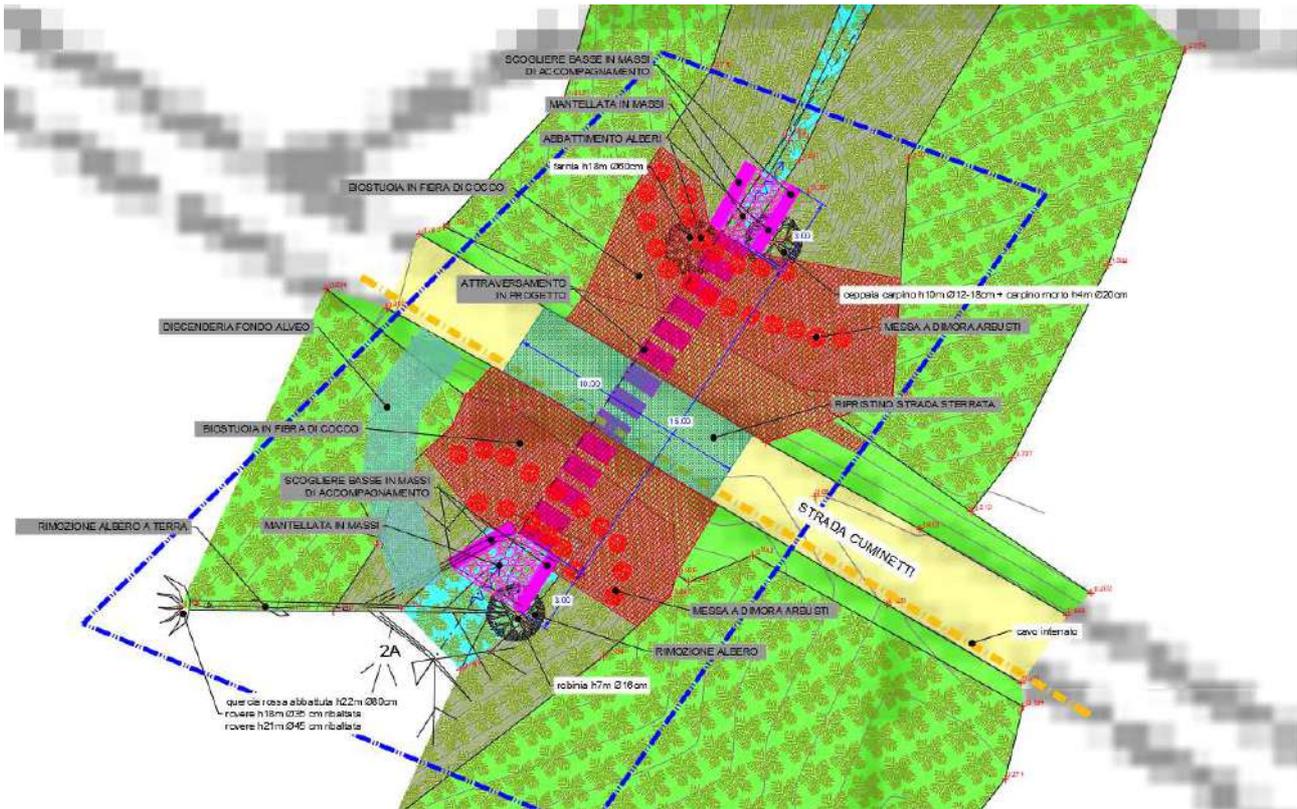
Planimetria di progetto. (rappresentazione non in scala)
